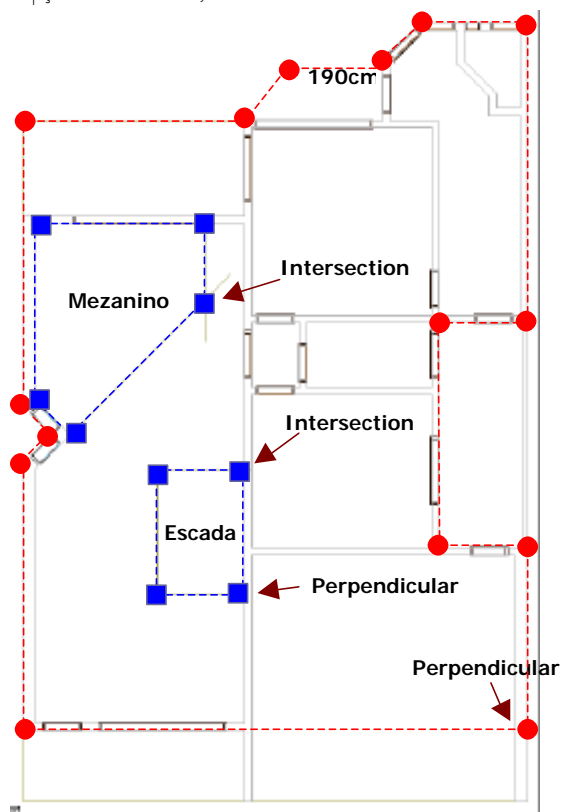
Pontos das poligonais utilizadas para desenho do piso do segundo pavimento, baseadas nas linhas auxiliares e nas paredes do primeiro pavimento.
